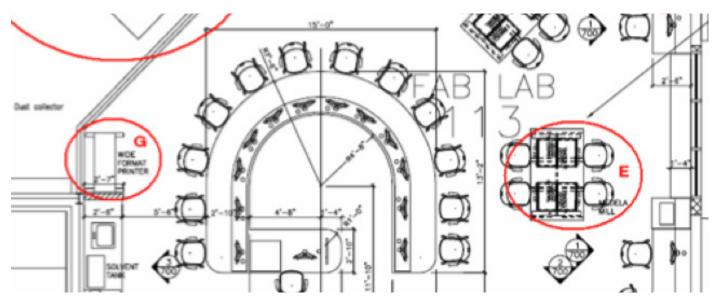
Plan d'occupation du Fab Lab LCCC - Source EDP/Labtec
